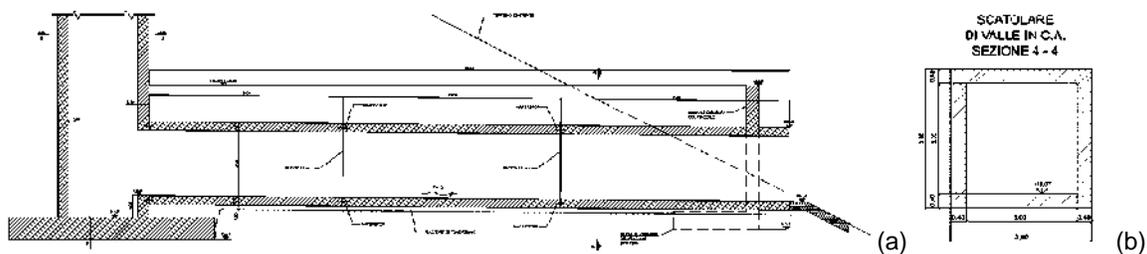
Fosso Nicolino, manufatto scatolare di valle: (a) sezione longitudinale e (b) sezione trasversale
